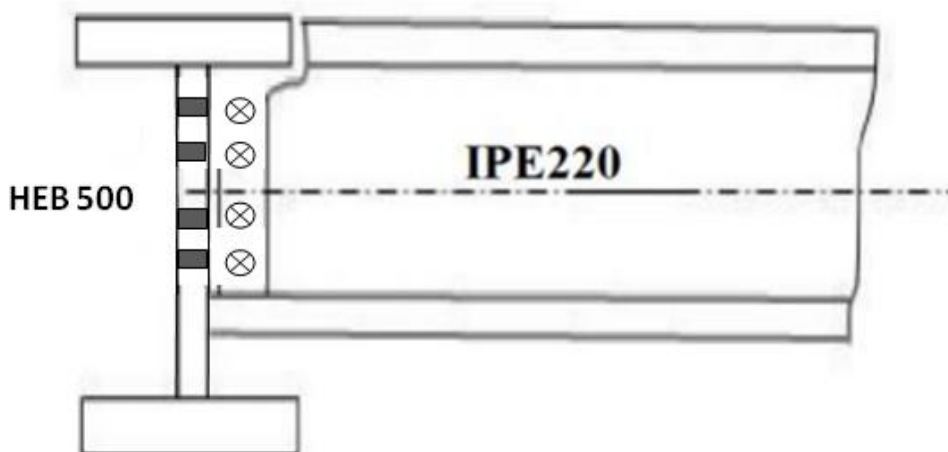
Schéma statique de l'assemblage poutre-solive (HEB 500-IPE 220).
